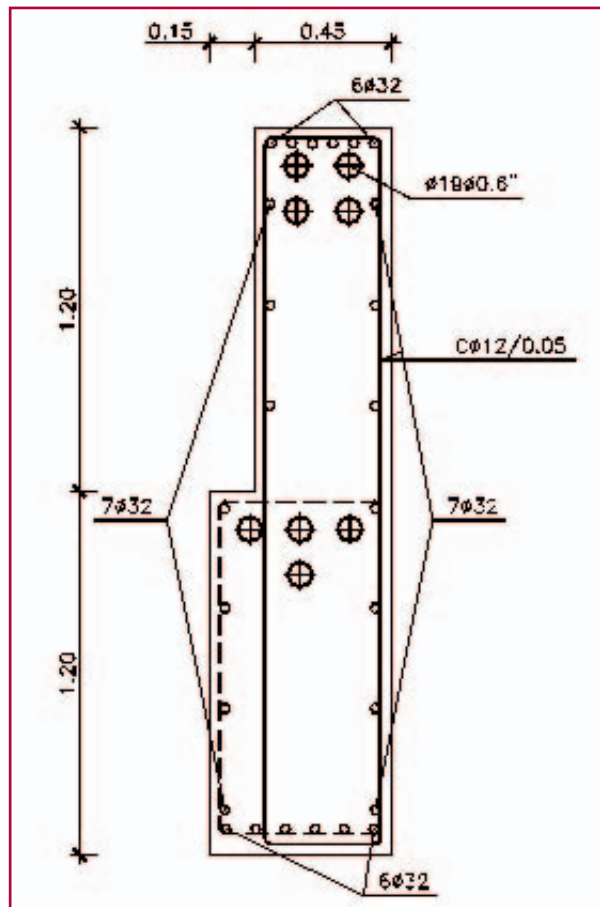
Sección tipo de las vigas en voladizo, incluyendo las armaduras principales y los cables de pretensado.
